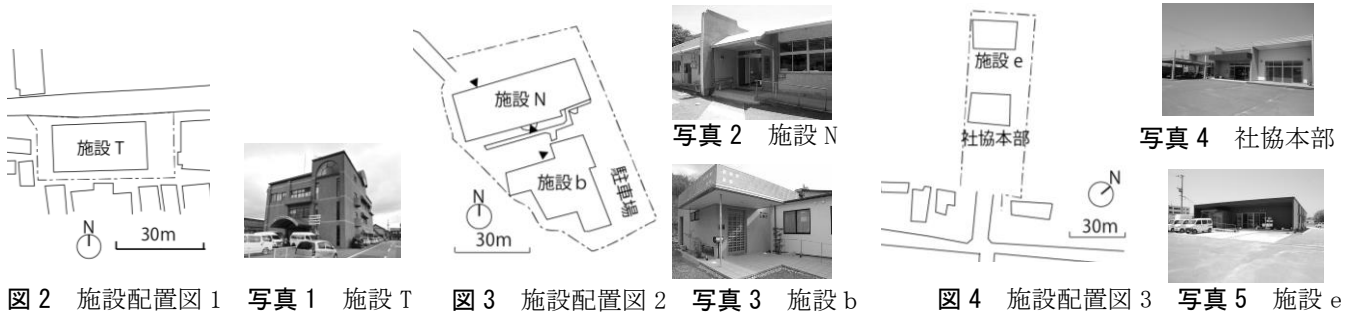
施設配置図1 写真1 施設 T 図3 施設配置図2 写真3 施設 b 図4 施設配置図3 写真5 施設 e
